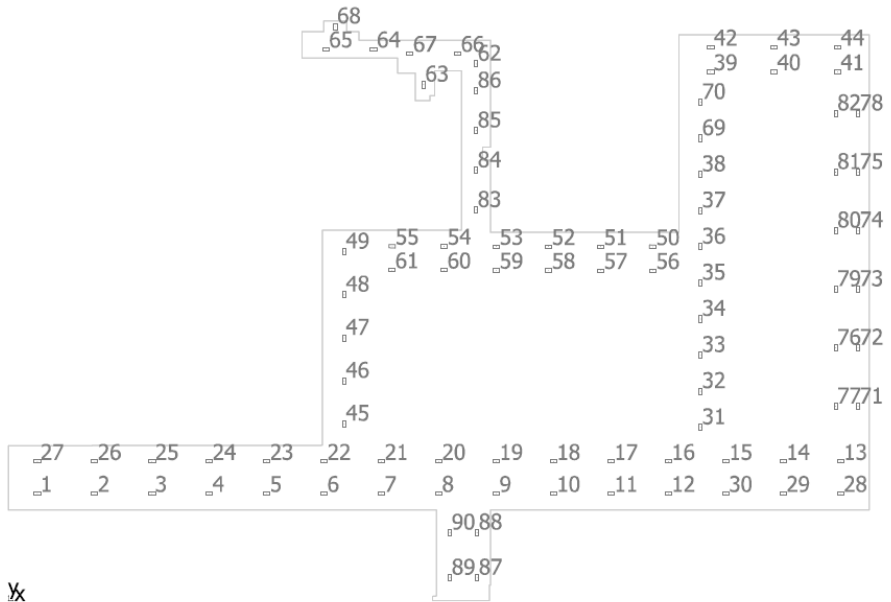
Propuesta de iluminación piso 3. Fuente, los autores.
